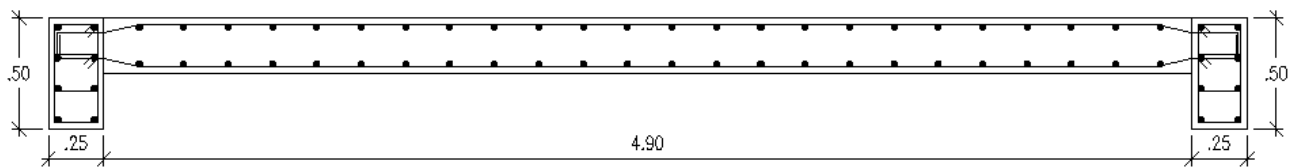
Sección típica de armado de placa con núcleos de confinamiento en los bordes.
